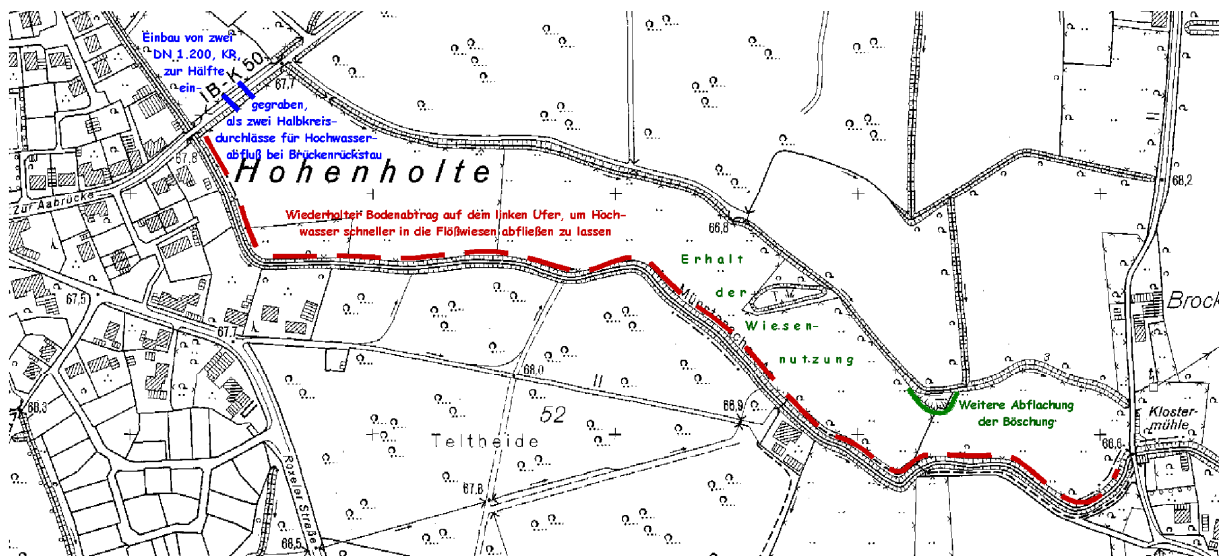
Auszug aus dem KNEF für den geplanten Maßnahmenbereich (U Plan 2003)
